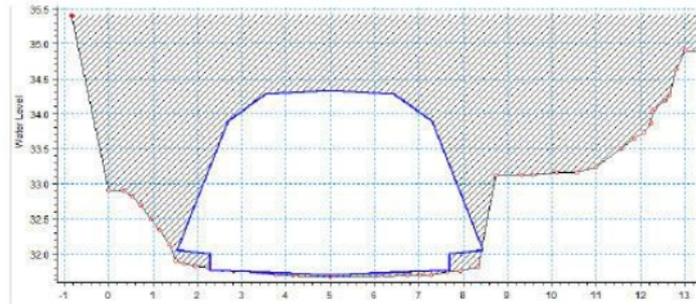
modélisation d'un ouvrage hydraulique avec banquettes et illustration d'une banquette en encorbellement (source : étude d'impact)
